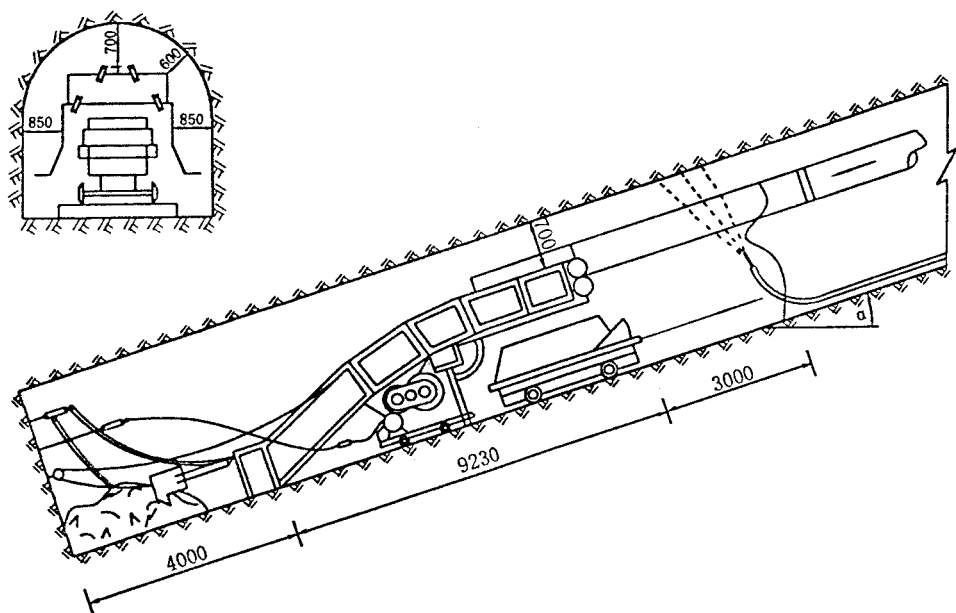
钻眼、装岩、支护平行作业工作面布置图
